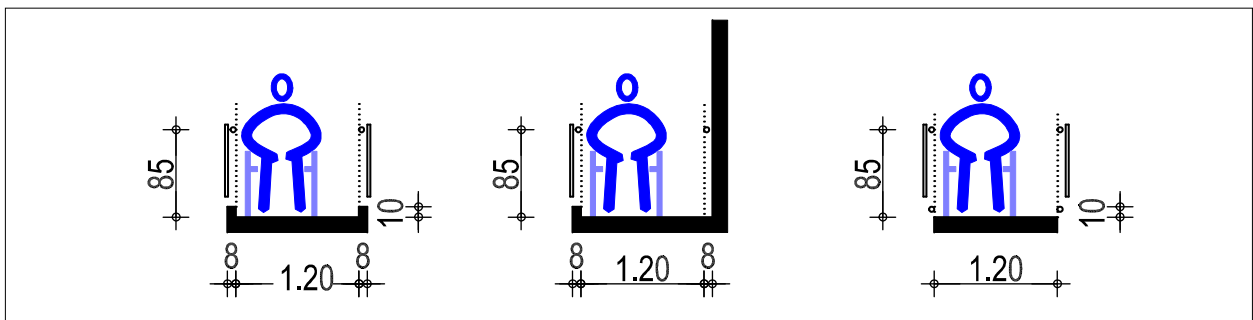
Maßangaben zu Rampenanlagen – Querschnitte
